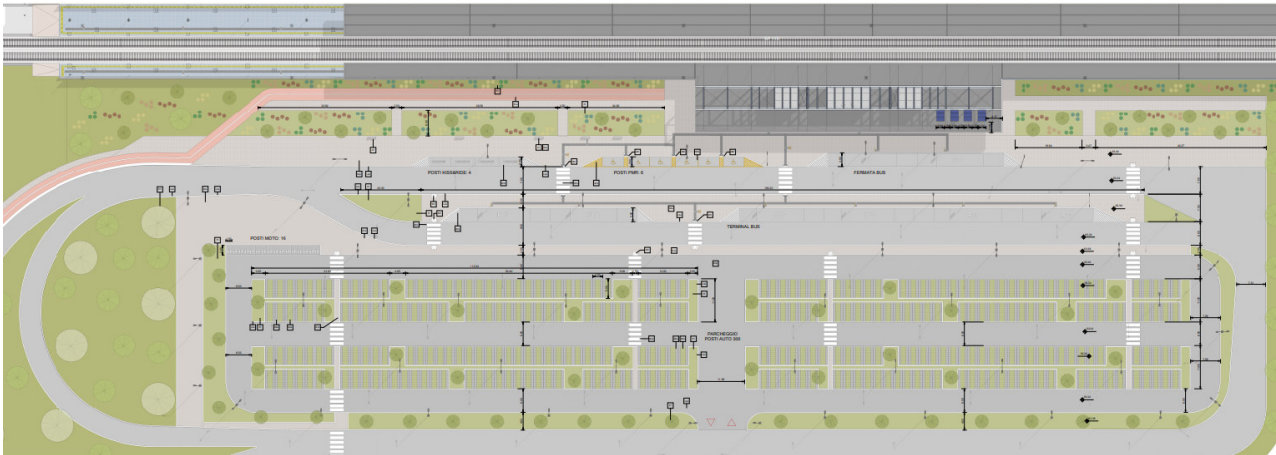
Vista Planimetrica del parcheggio della nuova Fermata AV di Foggia
